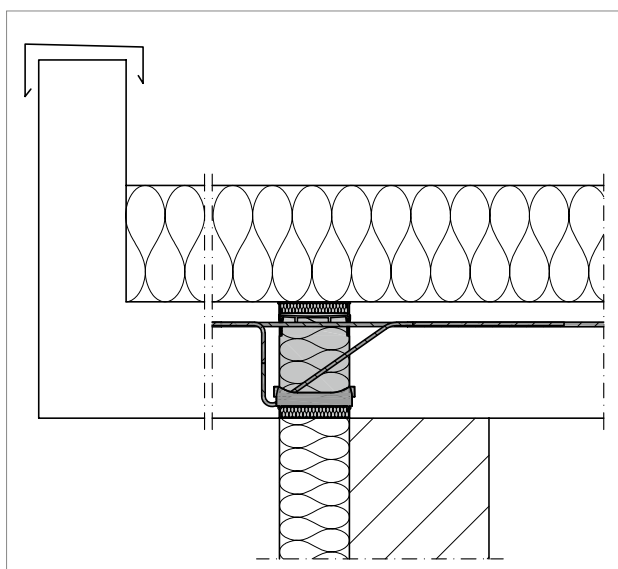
Schöck Isokorb® T Type K : Raccordement d'un auvent
